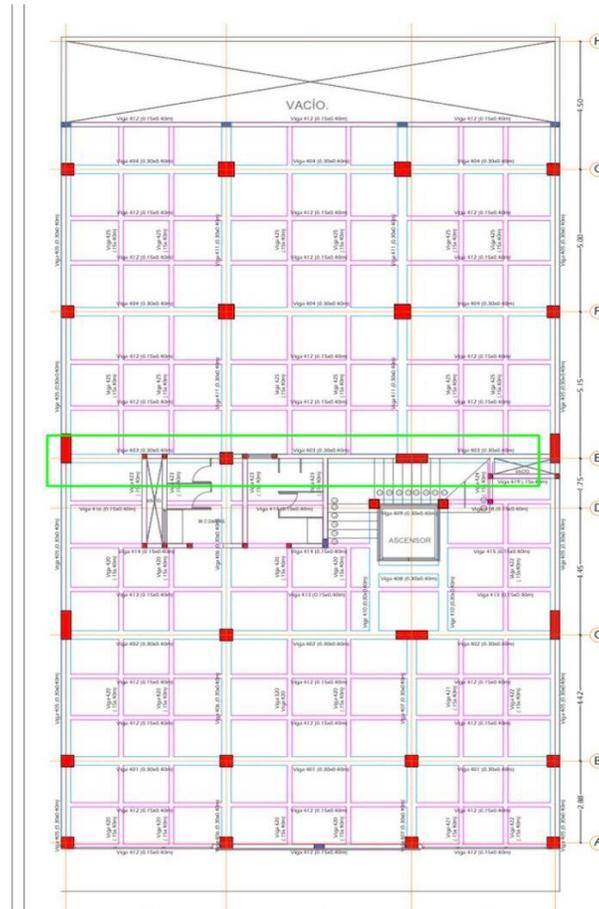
Ubicación de viga403 vista en planta de plano estructural Wiedii
